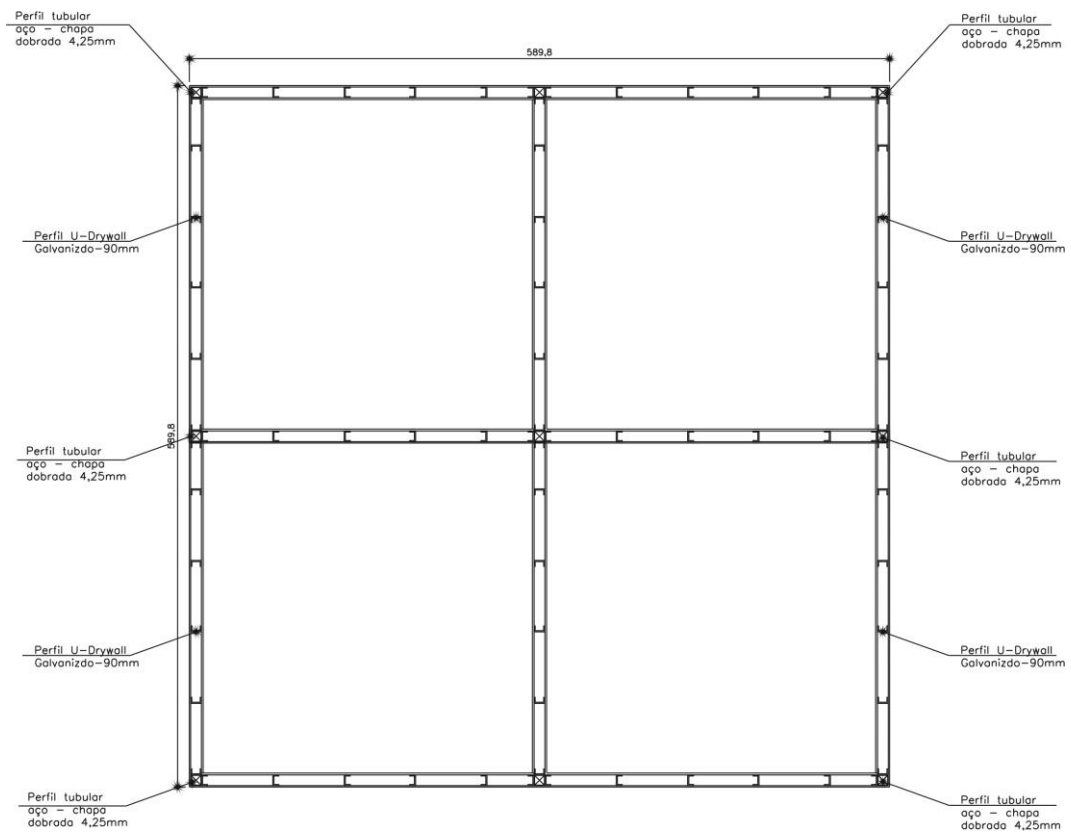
Planta com modulação de pilares e paredes Drywall – Modelo arquitetônico 34,69 m².
